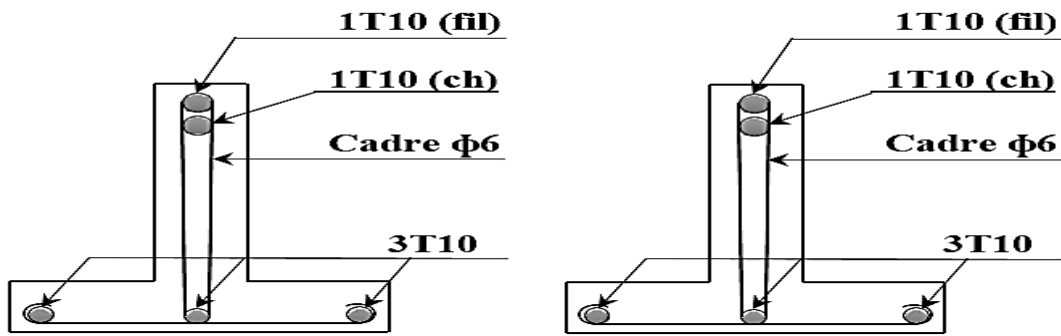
Dessin de ferrailage des poutrelles de la terrasse
